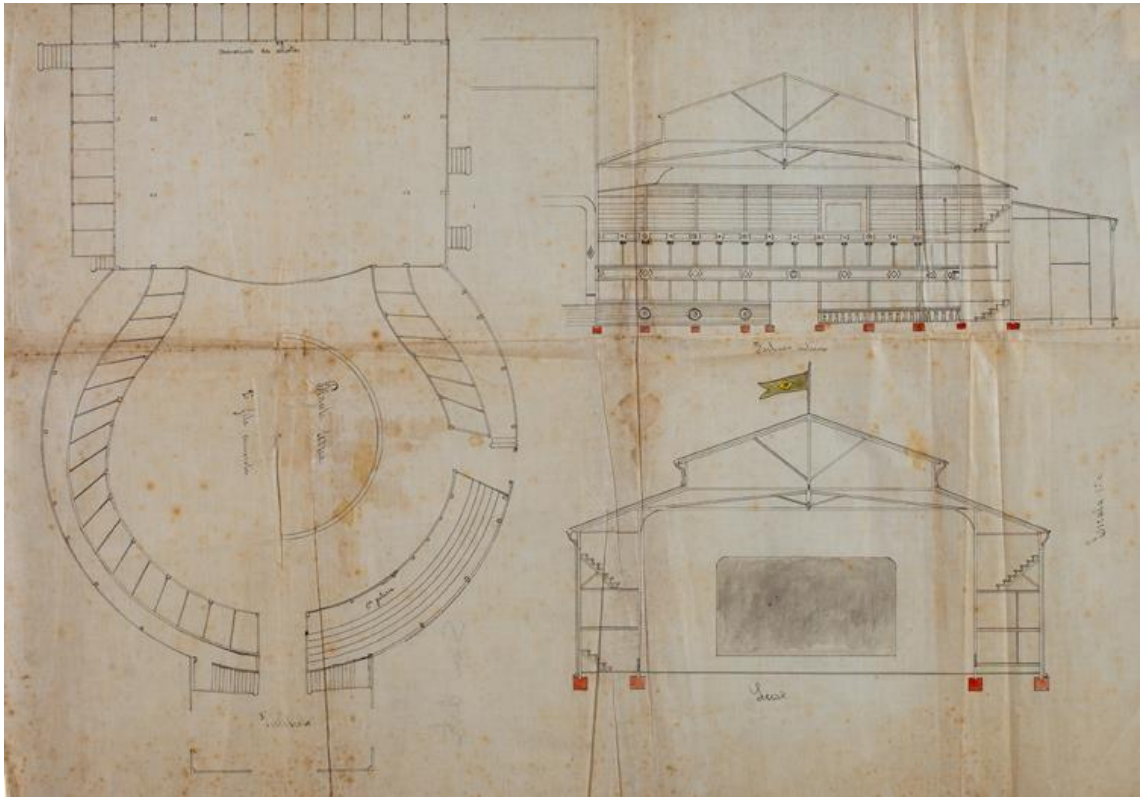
Desenhos originais. Planta e dois cortes. Fonte: AHSP, Coleção de Plantas da Cidade de São Paulo, Mapoteca 2: Número 229, notação: VILE 4, 1898.
